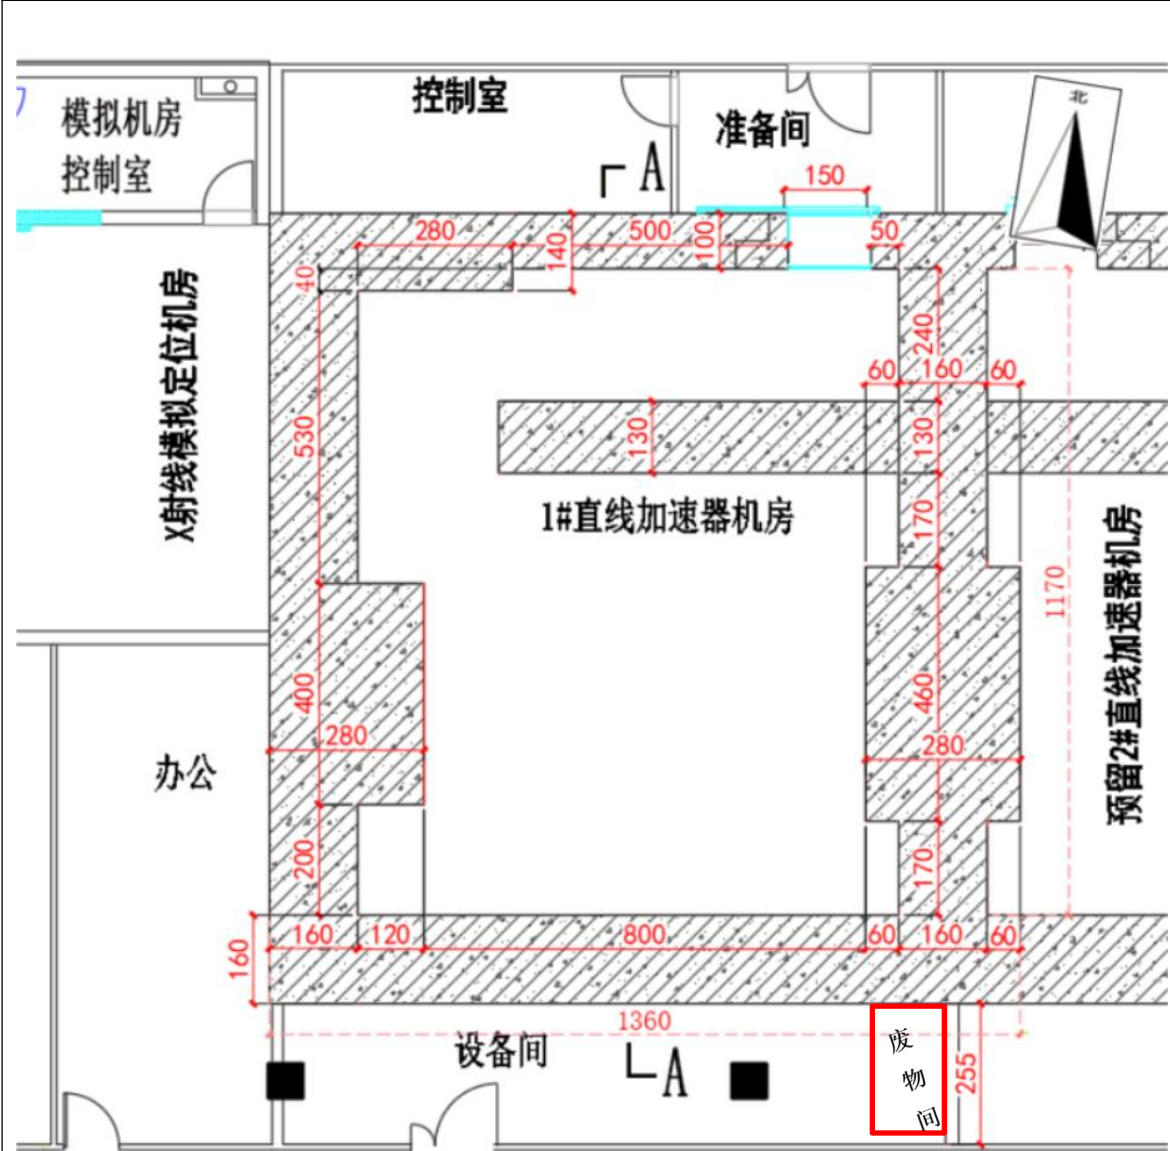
放疗中心 1#机房屏蔽现状平面图（图中尺寸单位：cm）
